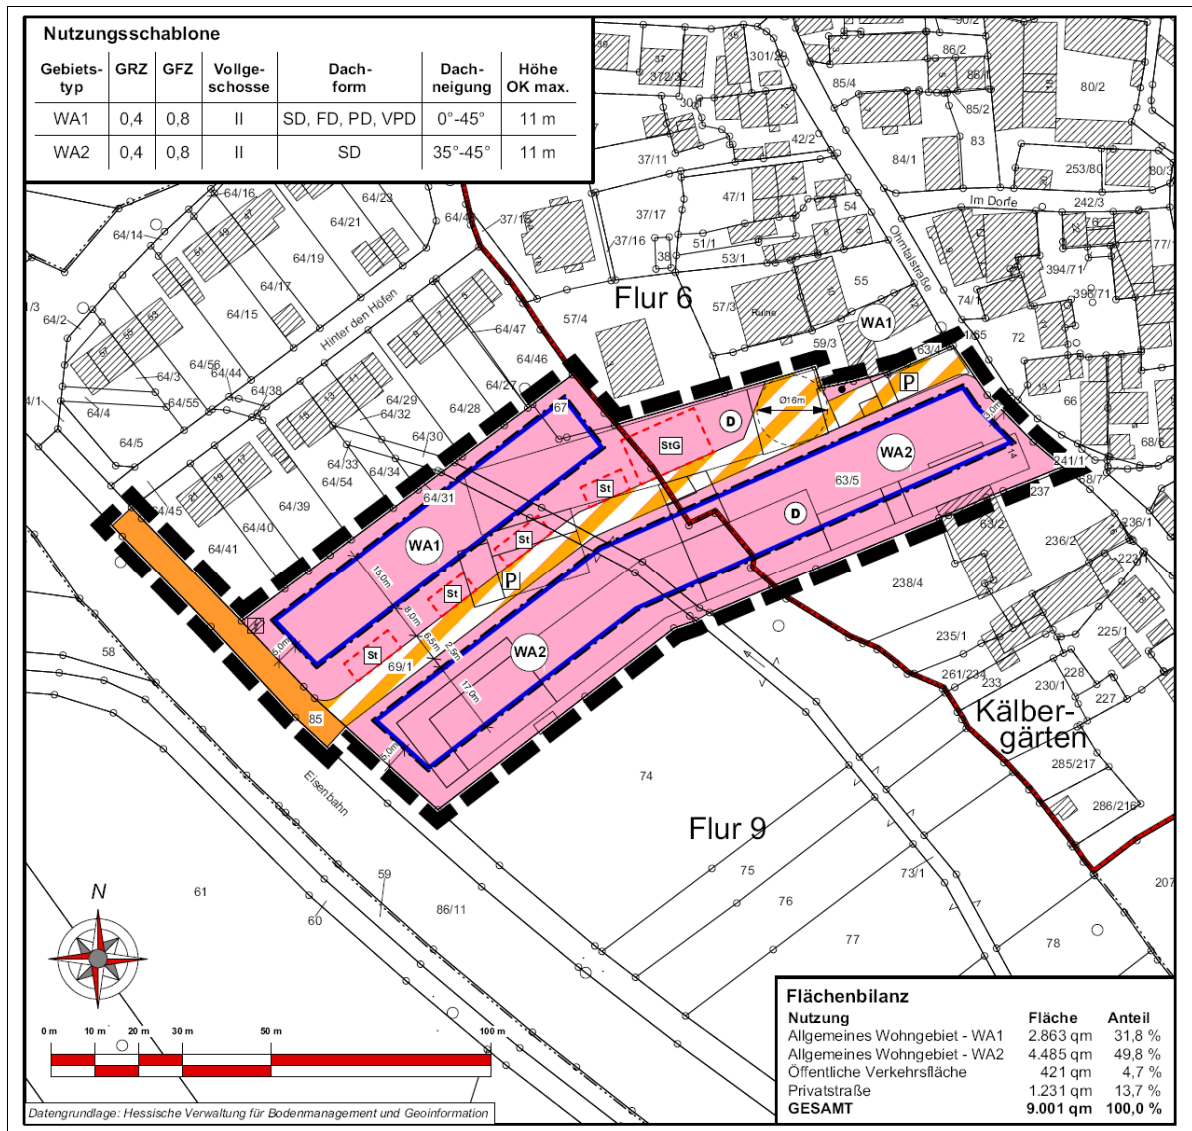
Vorentwurf des Bebauungsplans (Ausschnitt Planteil).
